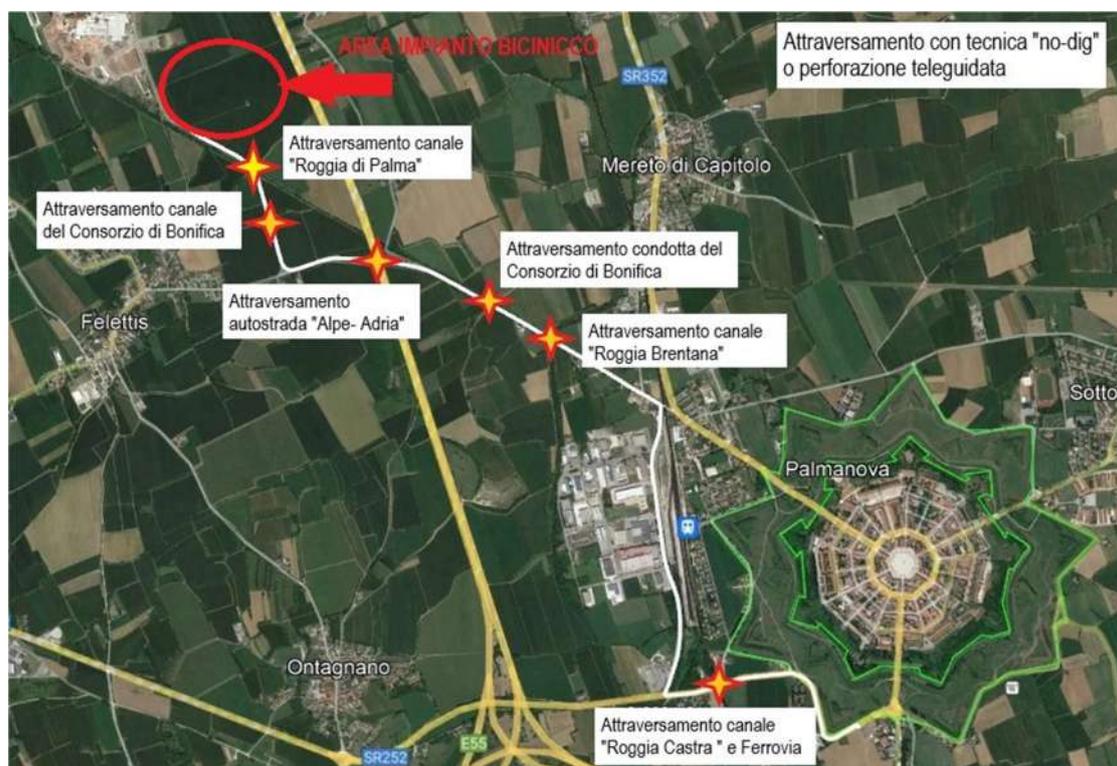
Planimetria degli attraversamenti con tecnica “No-dig” o perforazione teleguidata
